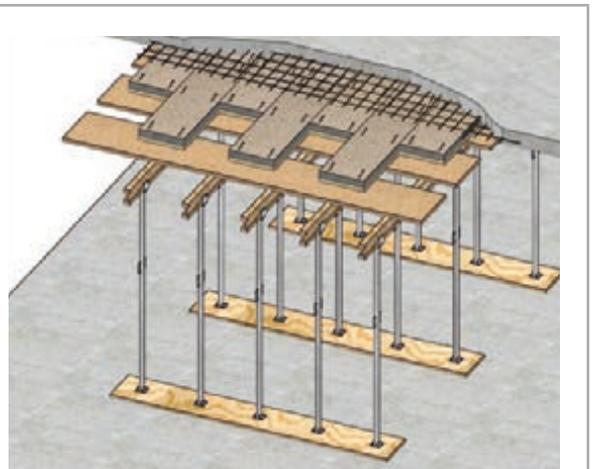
Mise en place des panneaux en coffrage isolant traditionnel
